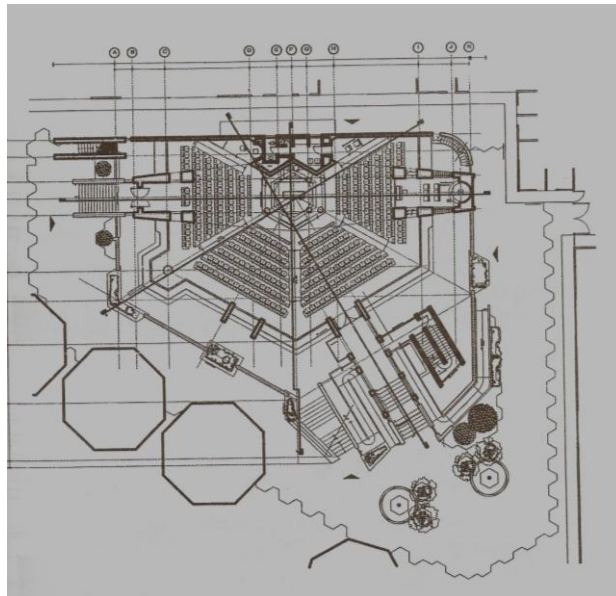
Planta arquitectónica de un edificio.<sup>51</sup>
